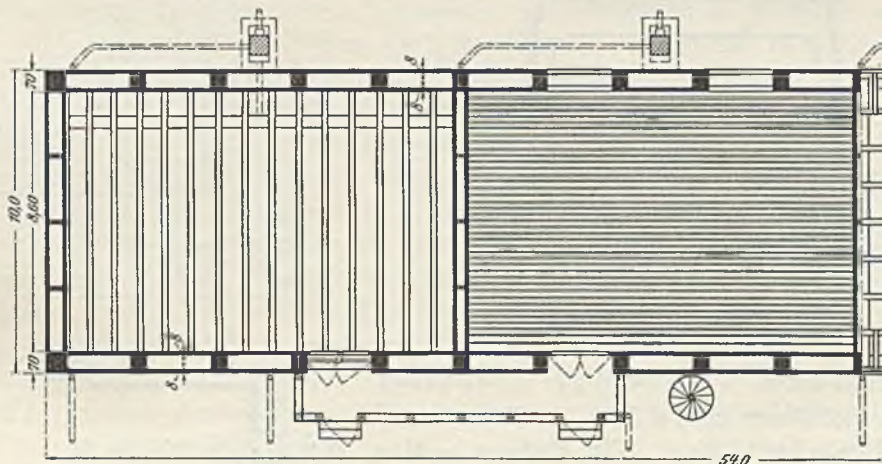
Eishaus für Cuxhaven, Grundriß.
